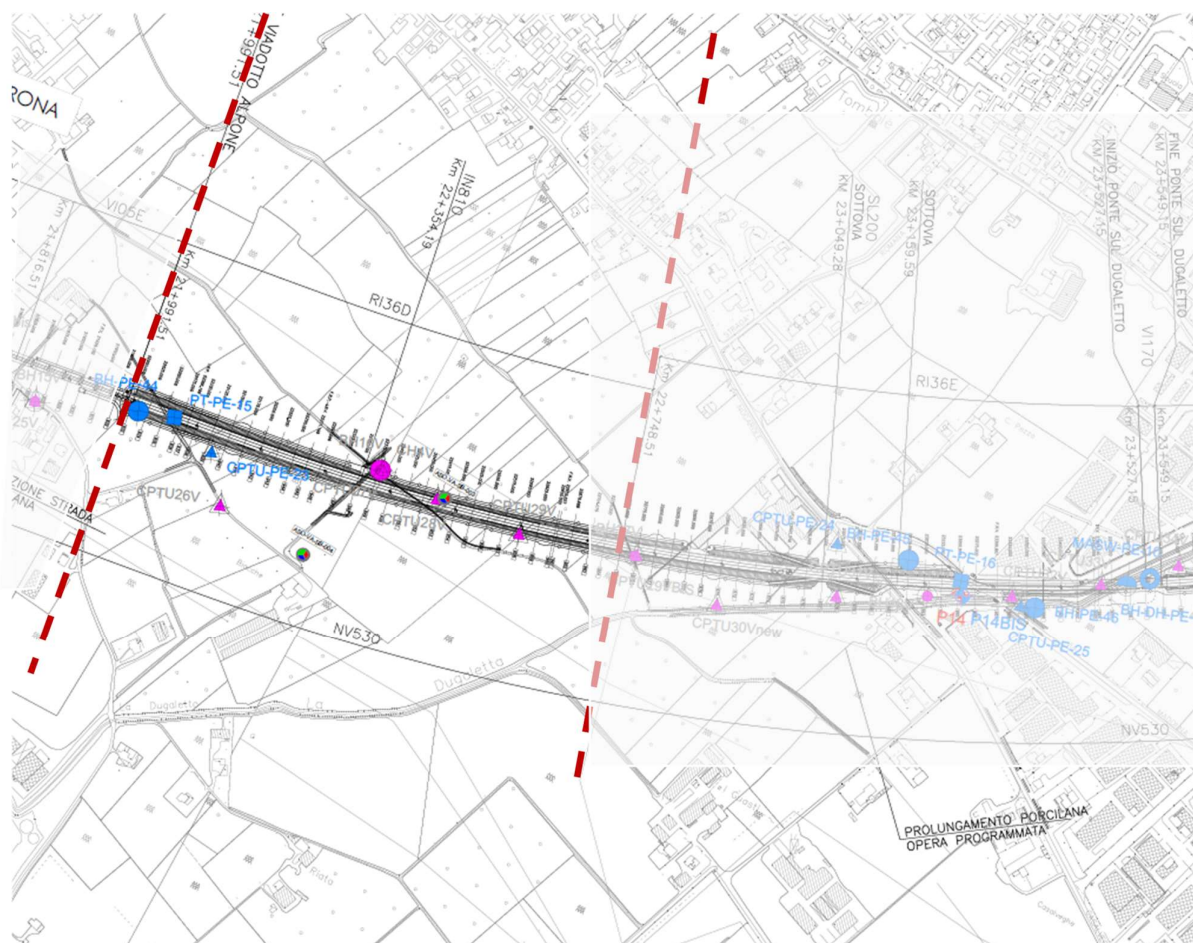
Planimetria Rilevato RI36D, estratto dalla Planimetria Generale (Doc. Rif. [3])
